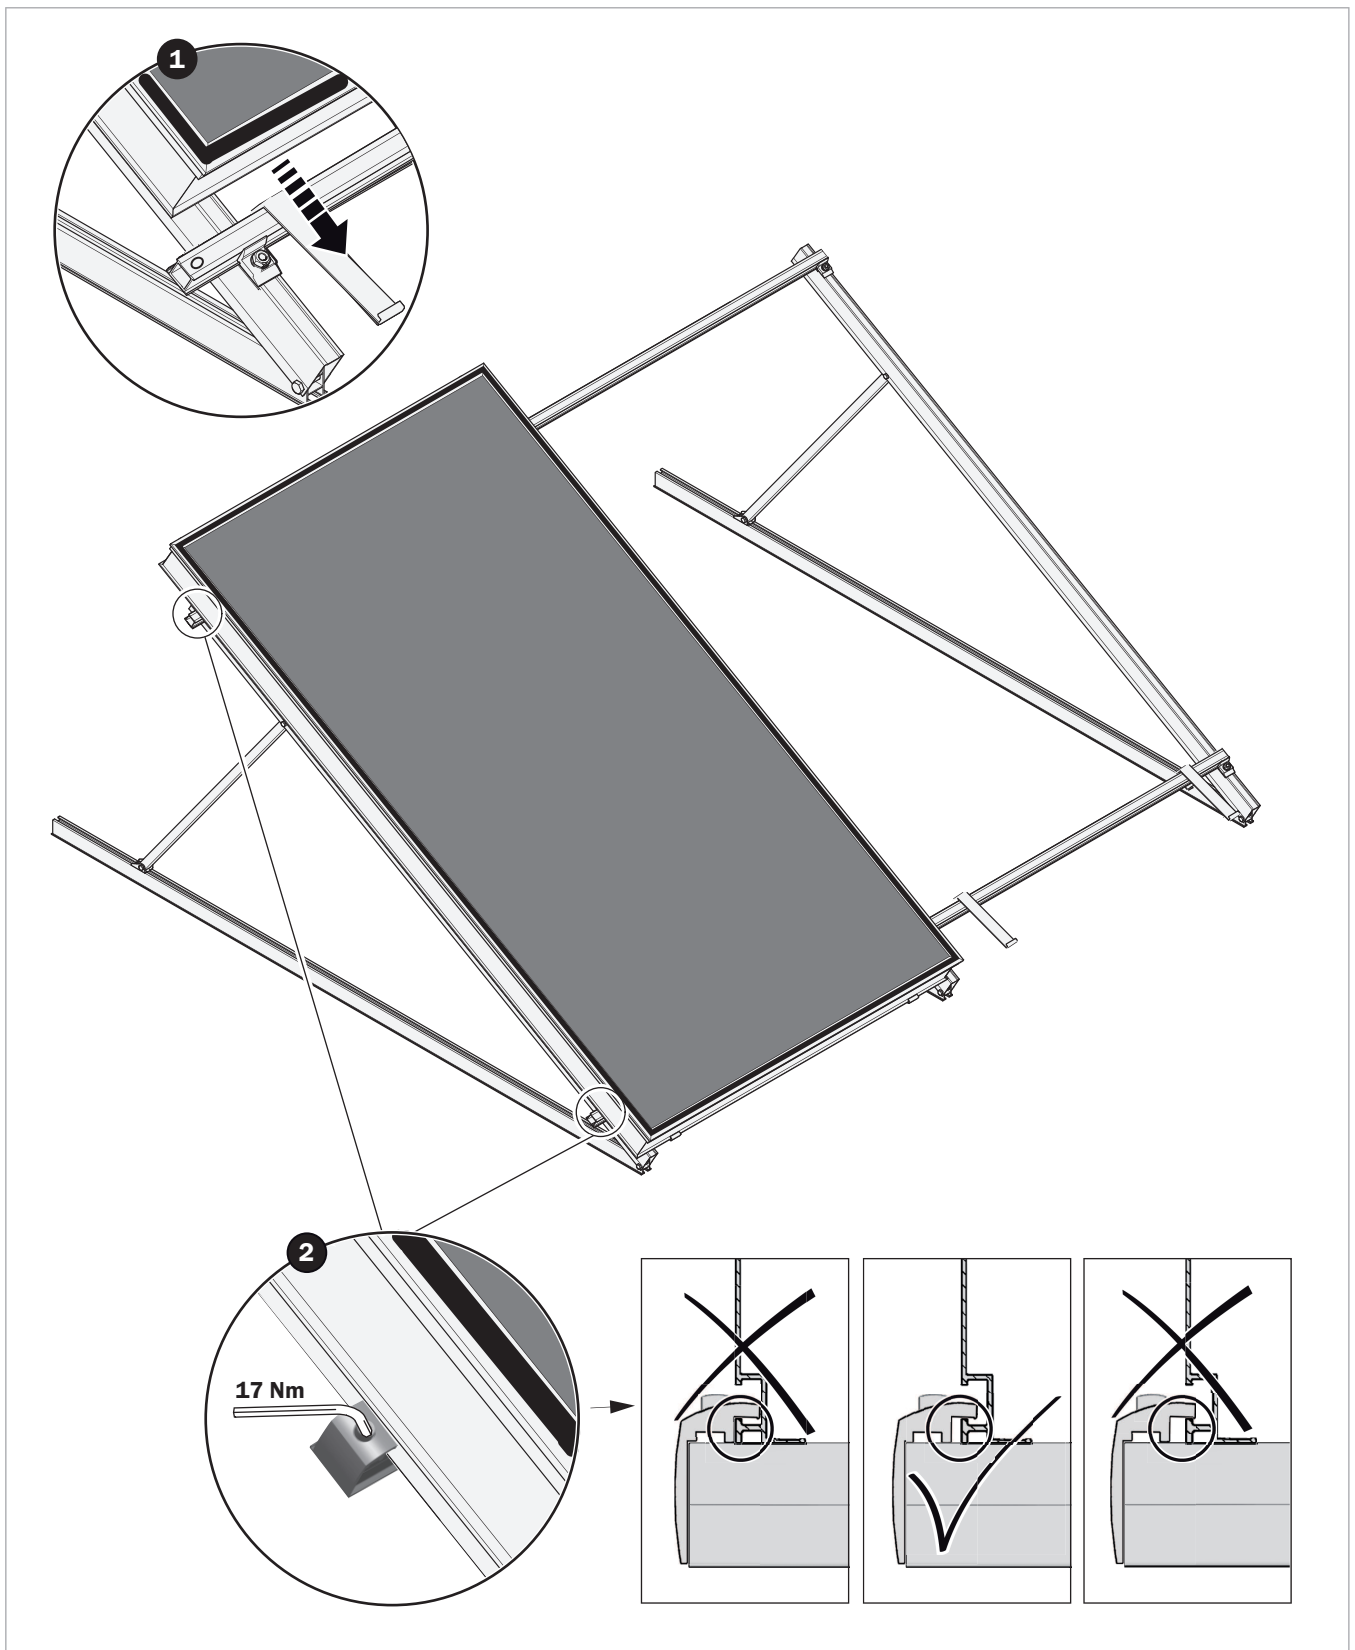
Fijación de un colector sobre los soportes para tejado plano
